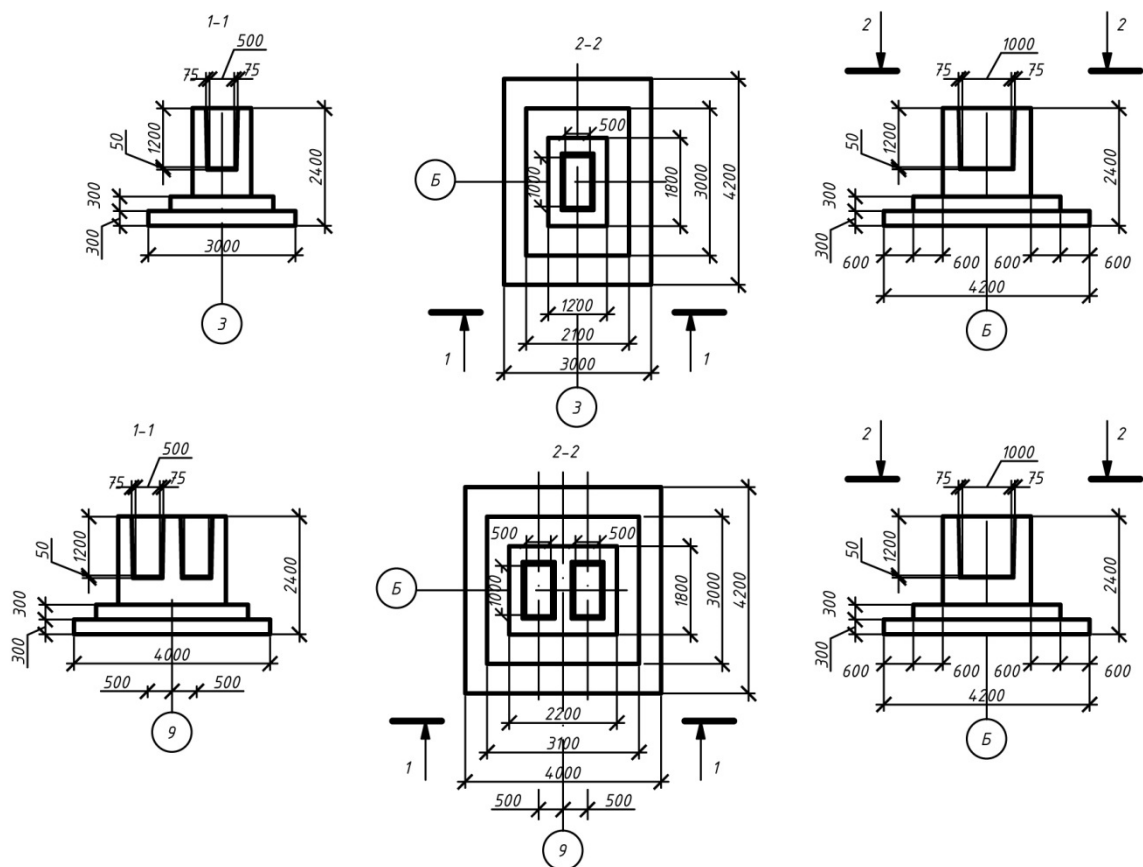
Схема фундаментов, расположенных по оси Б
